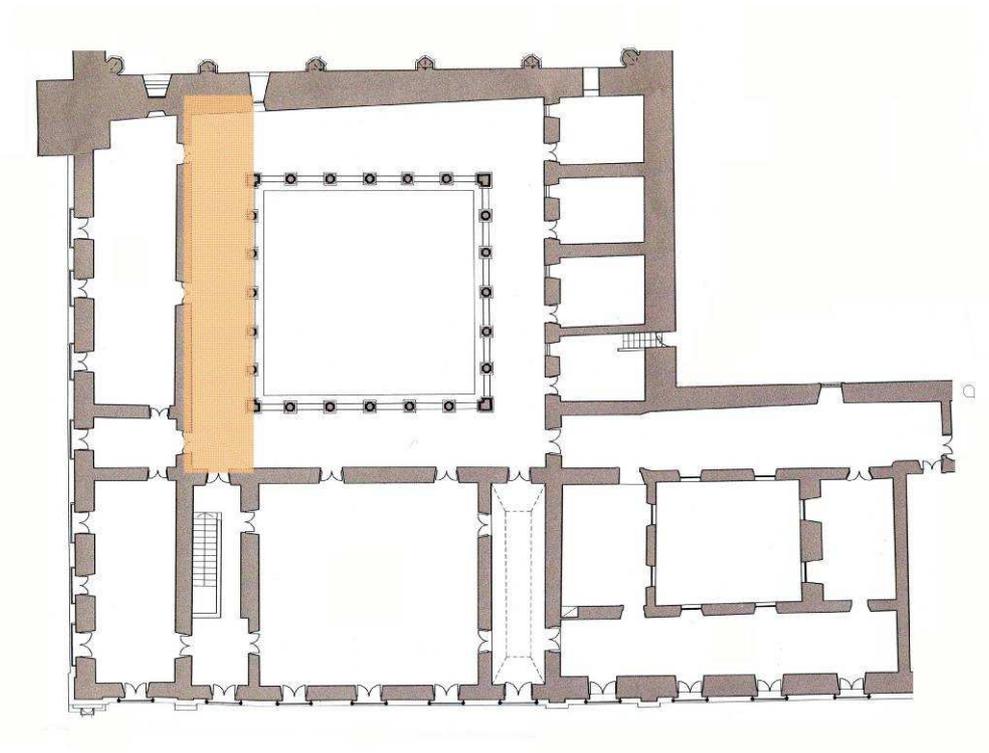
Localização da galeria Norte na planta do piso superior do levantamento de 2003.
